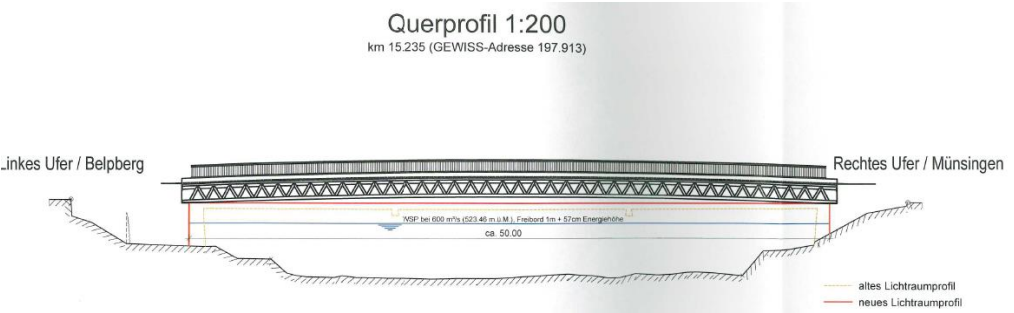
Variante Rohrfachwerkbrücke mit Betonplatte
